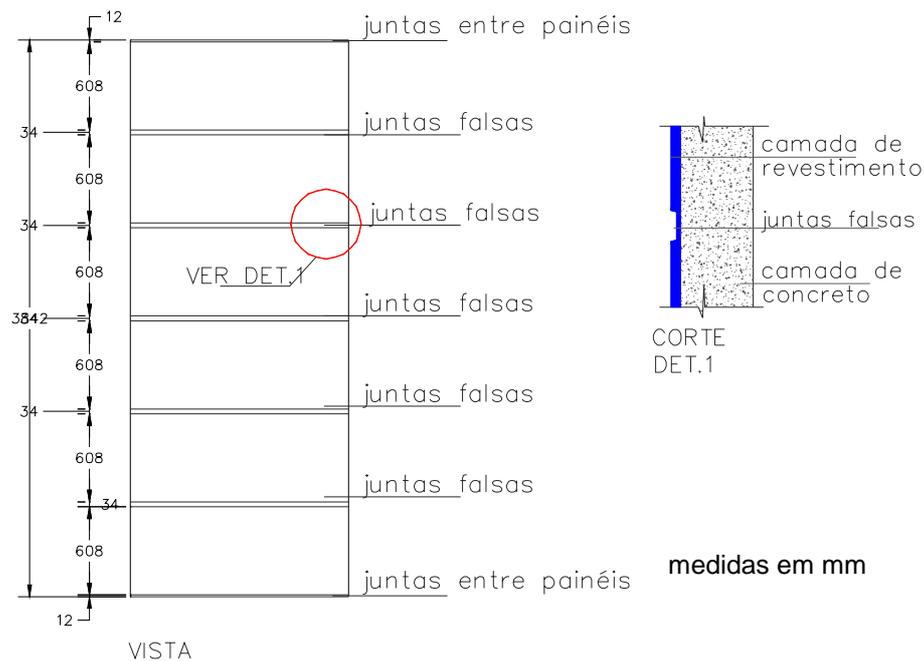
Esquema das juntas falsas – vista dos painéis que encobrem os pilares (Obra-2)
